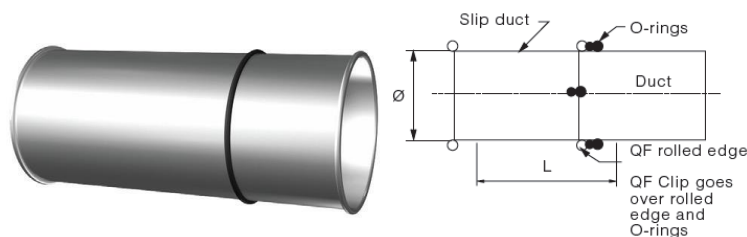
Condutas QFS (QFS Oil Mist & Cutting Fluid)
